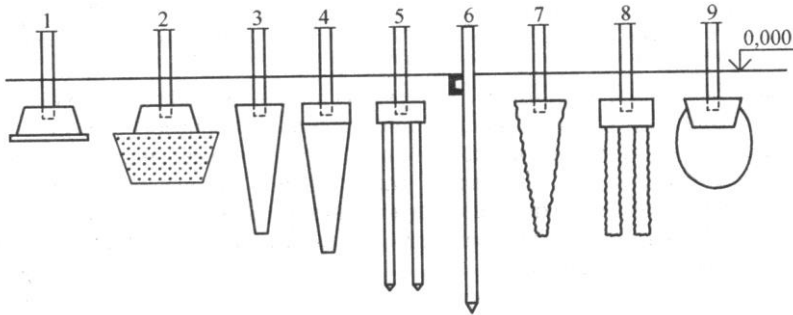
Фундаменти під колони каркасів і естакад: 1 - стовпчастий; 2 - на штучній основі; 3, 4 - пірамідальні палі; 5 - призматичні забивні палі; 6 - палія-колона; 7, 8 - набивні палі; 9 - фундамент у витрамбуваному котловані.
